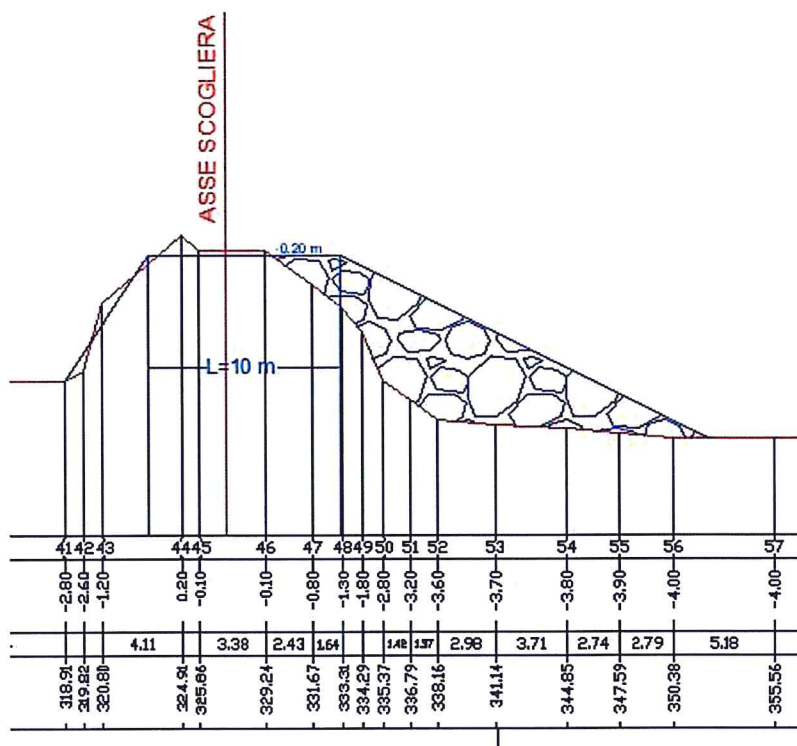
Sezione del modello di elevazione rilevato (in rosso) e della seconda ipotesi di scogliera di progetto (in blu).
